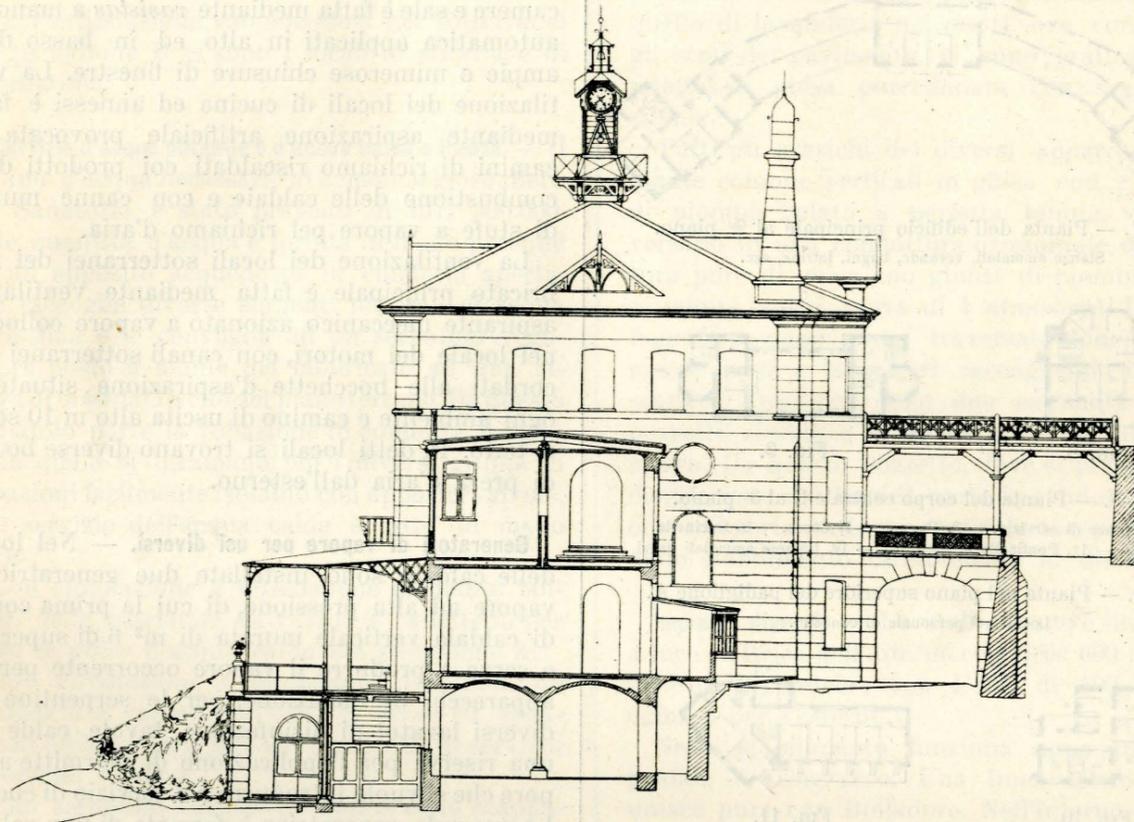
Sezione trasversale delle verande e vista laterale del fabbricato C (Scala 1:250).
